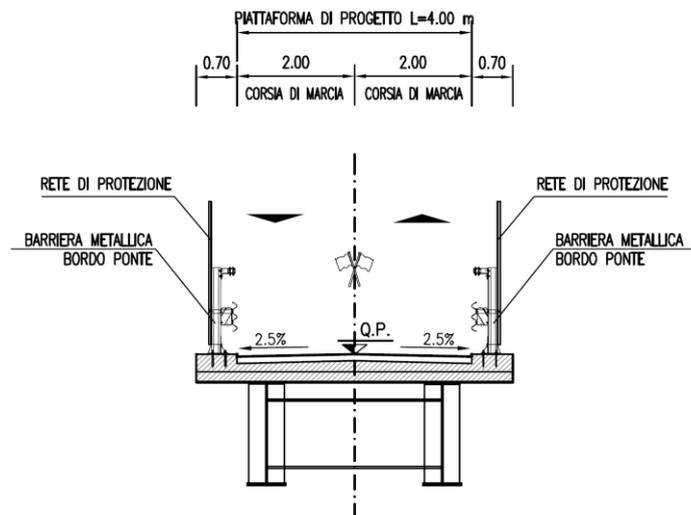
Sezione tipo su opera d'arte – Strada a destinazione particolare
